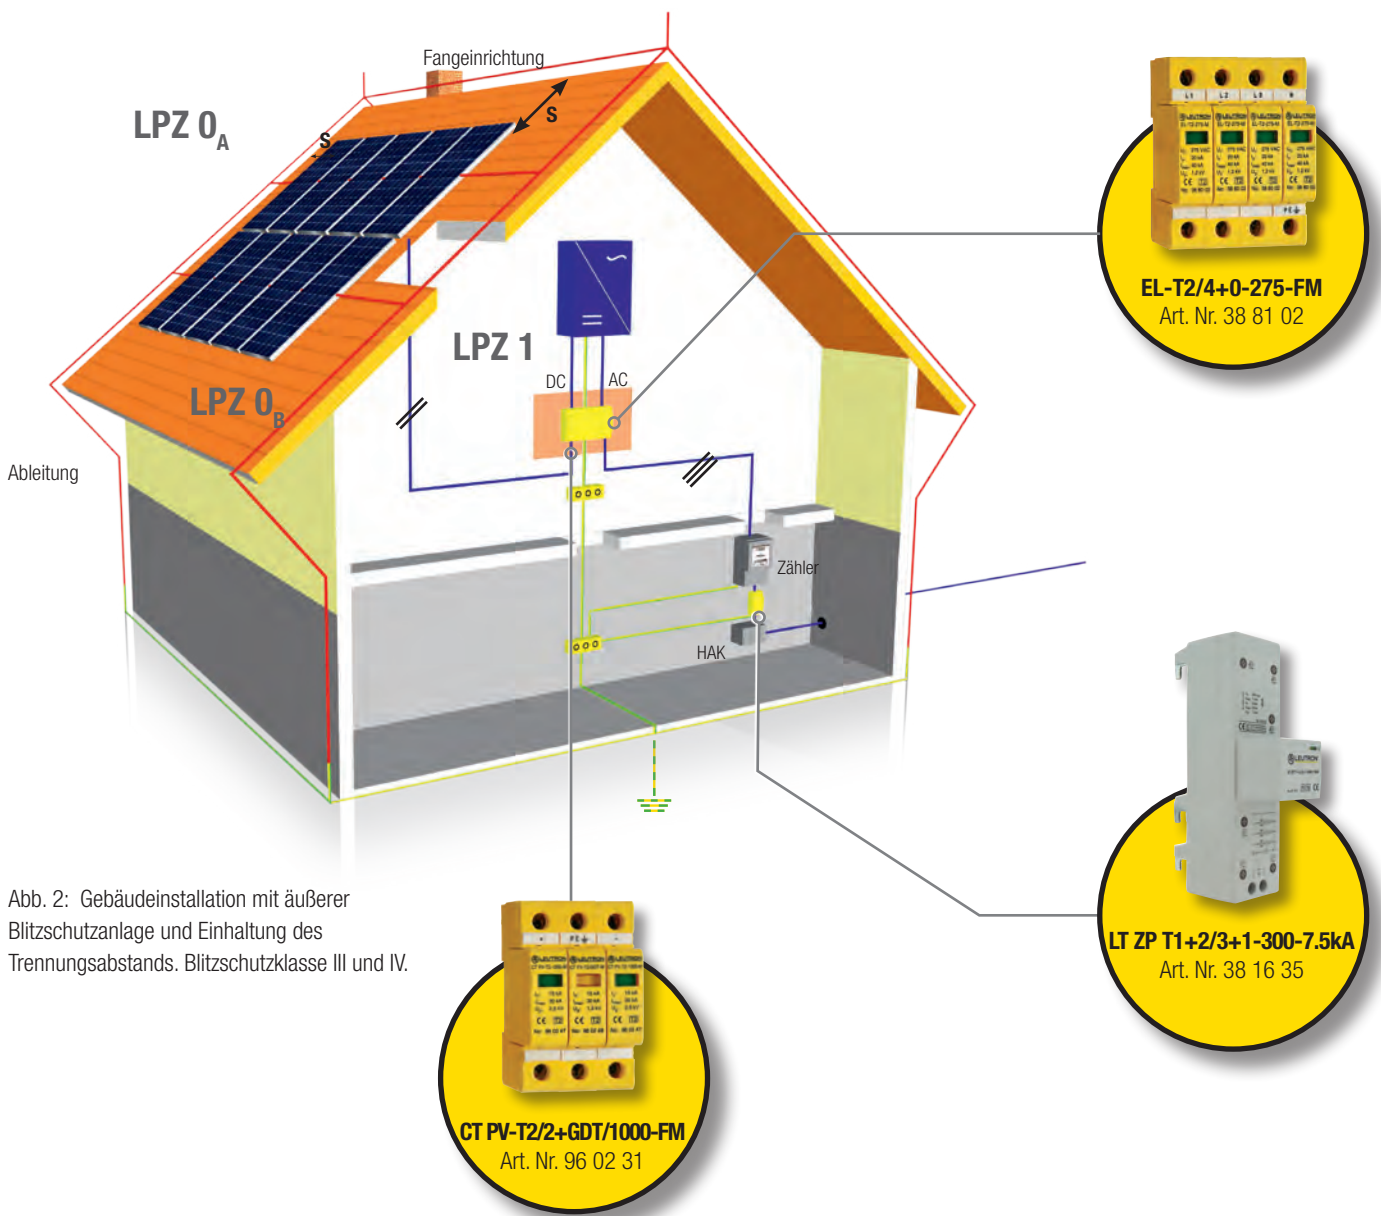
Gebäudeinstallation mit äußerer Blitzschutzanlage und Einhaltung des Trennungsabstands. Blitzschutzklasse III und IV.
